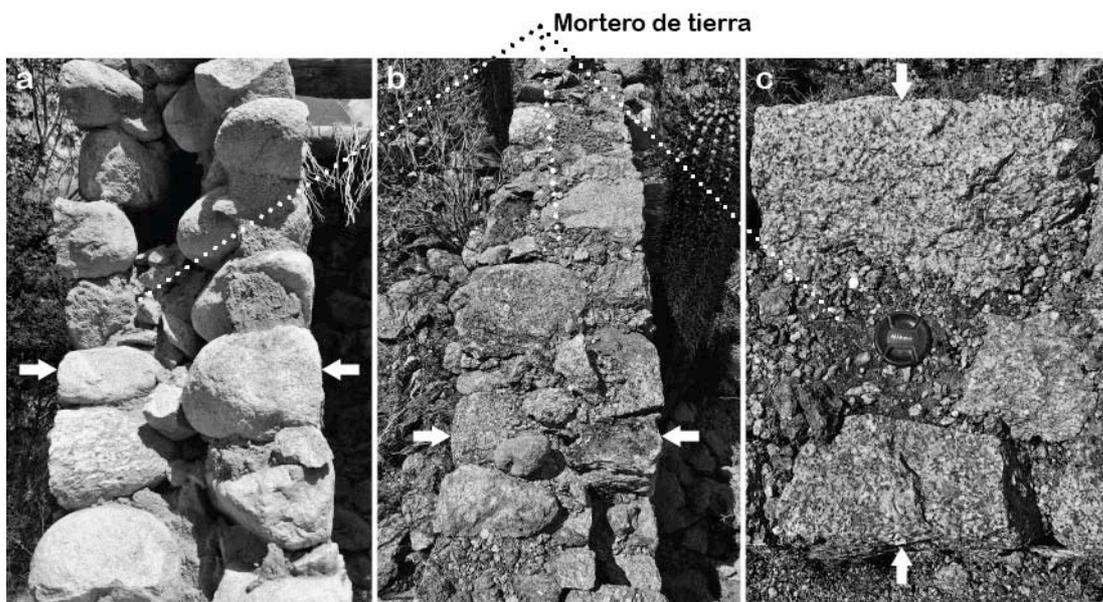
Empleo del doble lienzo con relleno interior de mortero de tierra y ripios para el armado de los muros a. Muro de piedras bola careadas, b y c. Muro de piedras con canto careadas. Flechas indican las superficies careadas. Fuente: Elaboración propia.
